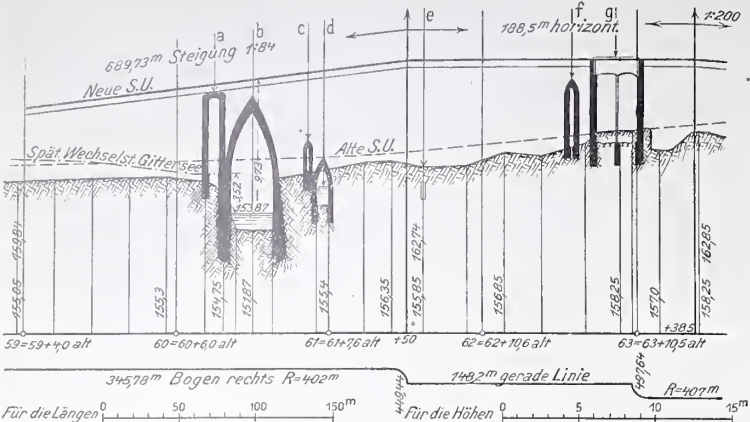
Längen- und Höhenplan der Eisenbahnlinie an der Brückenbaustelle.
